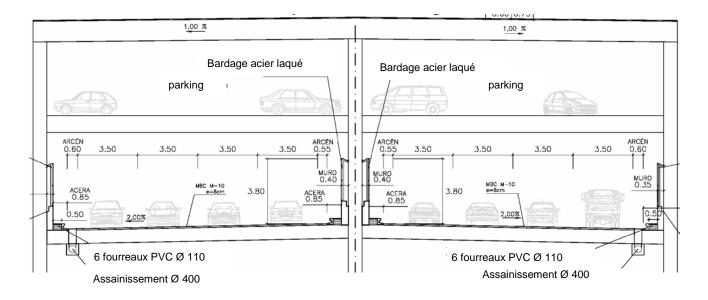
profil en travers de la branche principale : Avenue du Portugal
